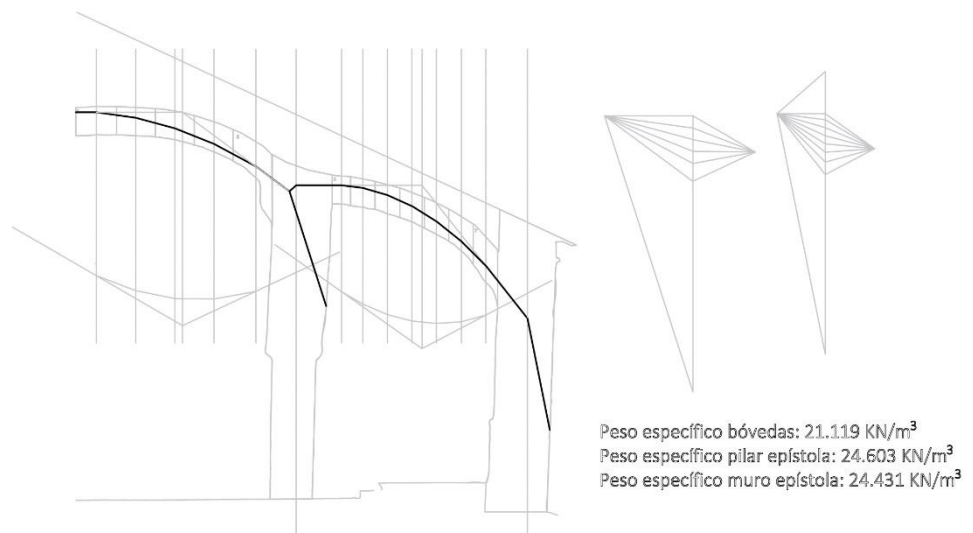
Estudio de la línea de presión por el plano de máxima inclinación del pilar P6 de Santa Eulària d'Unha
